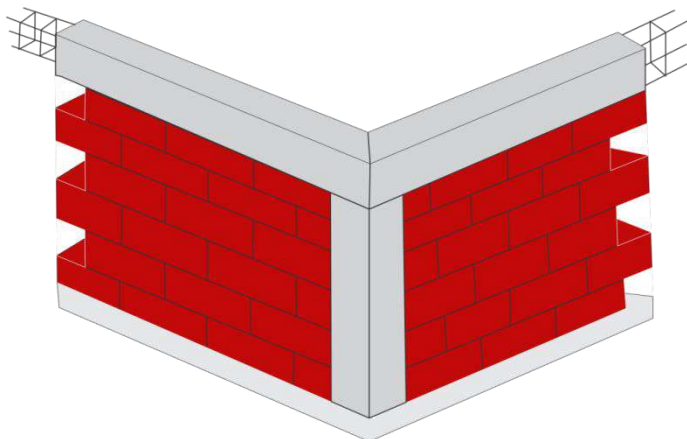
Edificação com armação de ferragens em suas estruturas
